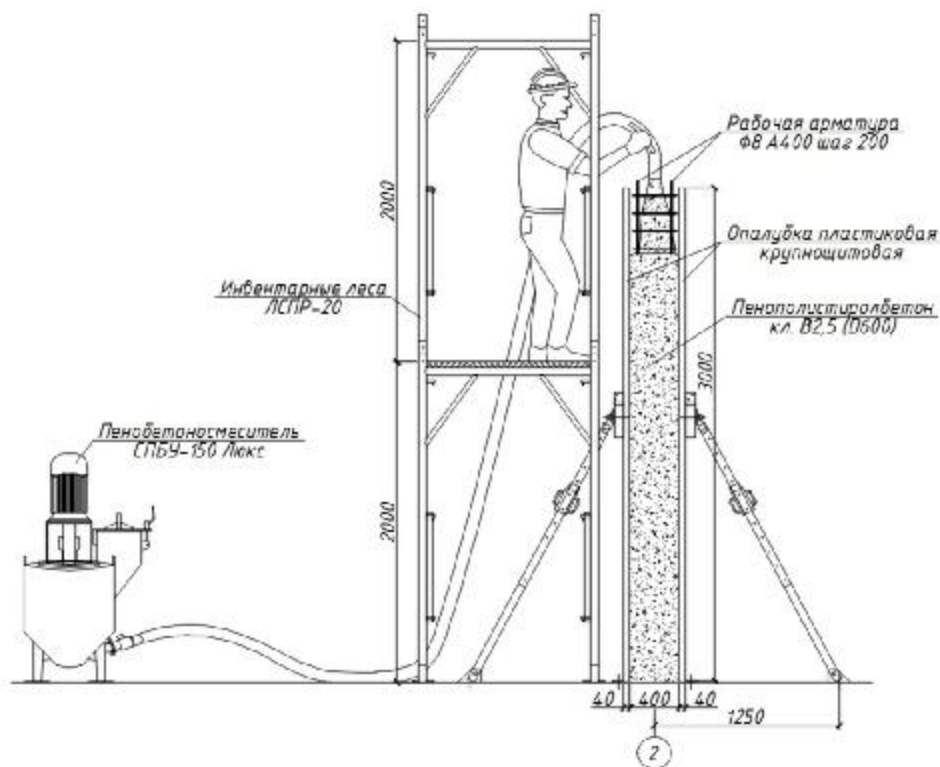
Принципиальная схема возведения монолитных стен из пенополистиролбетона в крупнощитовой пластиковой опалубке
